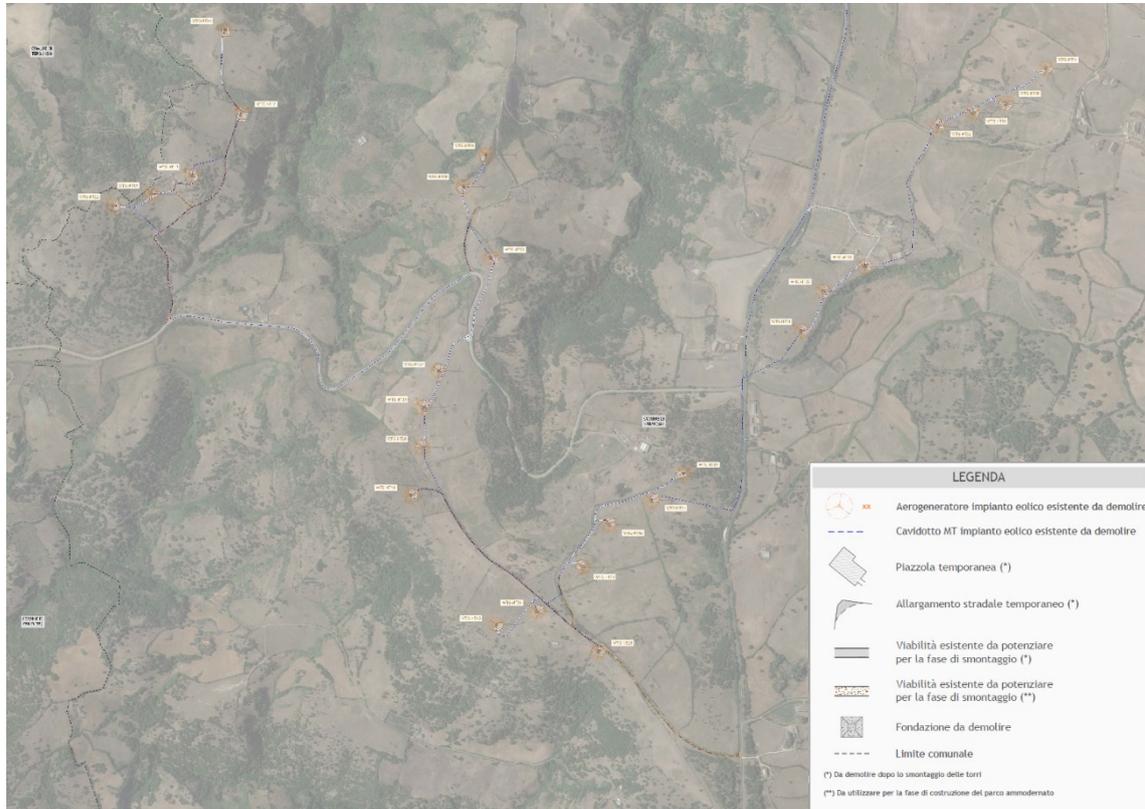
Stralcio della planimetria con individuazione dell'impianto eolico esistente su ortofoto
